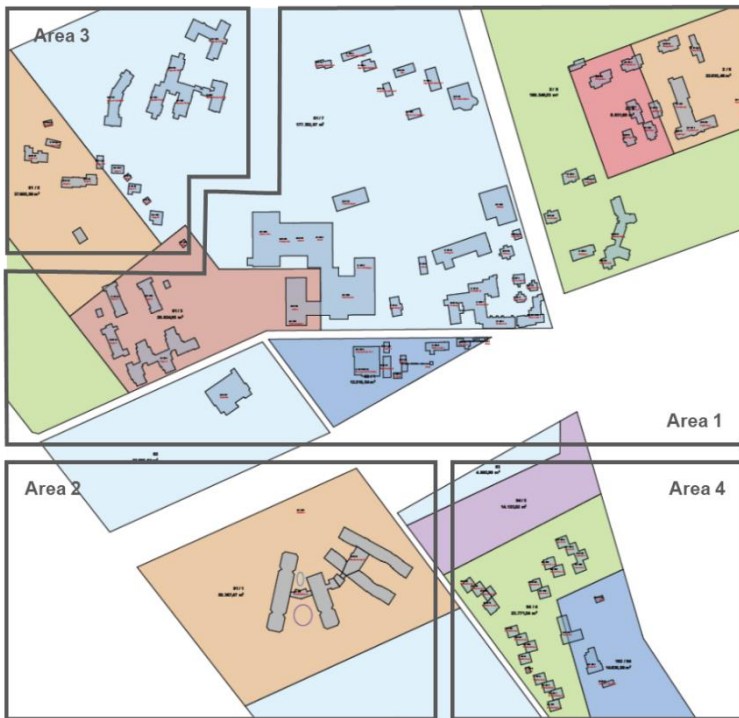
Lageplan Projekt 3. [energydesign braunschweig GmbH]
